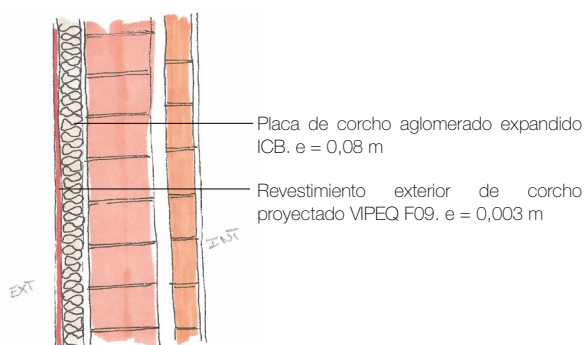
Sistema de aislamiento SATE aplicado las paredes de fachada (autoría propia).
